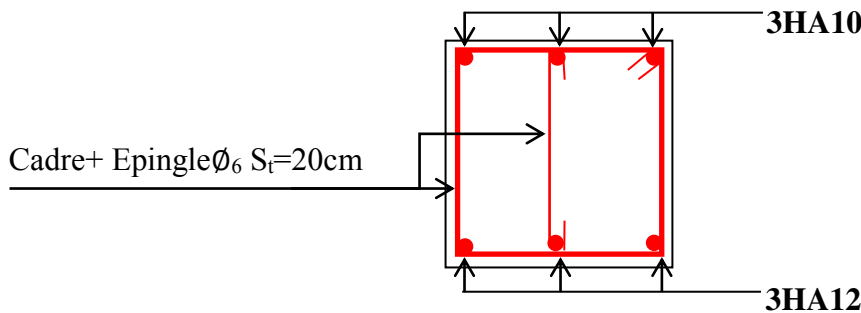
Schéma de ferrailage de la poutre de chaînage.
